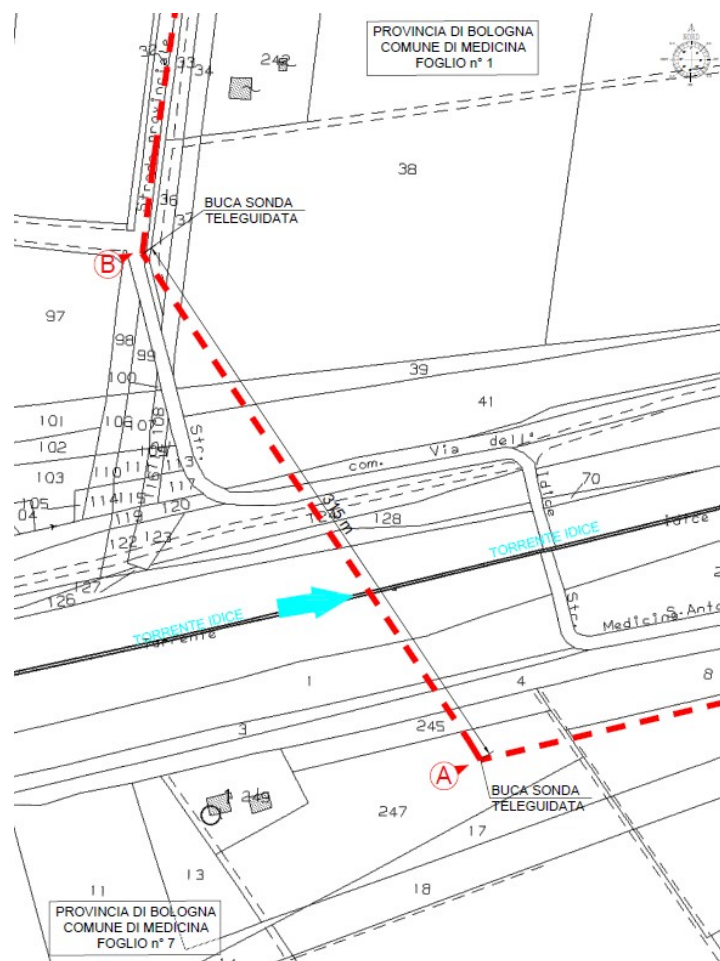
Planimetria dell'attraversamento con elettrodotto del torrente Idice
